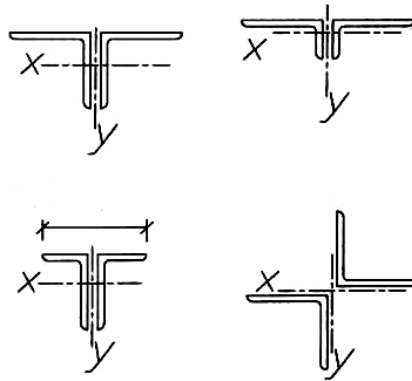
Типы сечений стержней ферм из парных уголков
